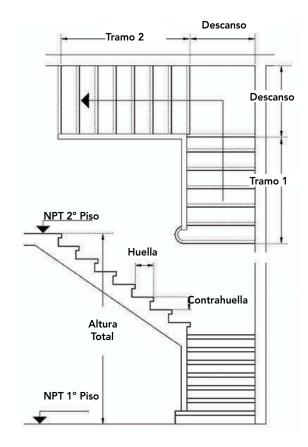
4: Planta y elevación tipo de una escalera de dos tramos en ángulo recto con descanso.
